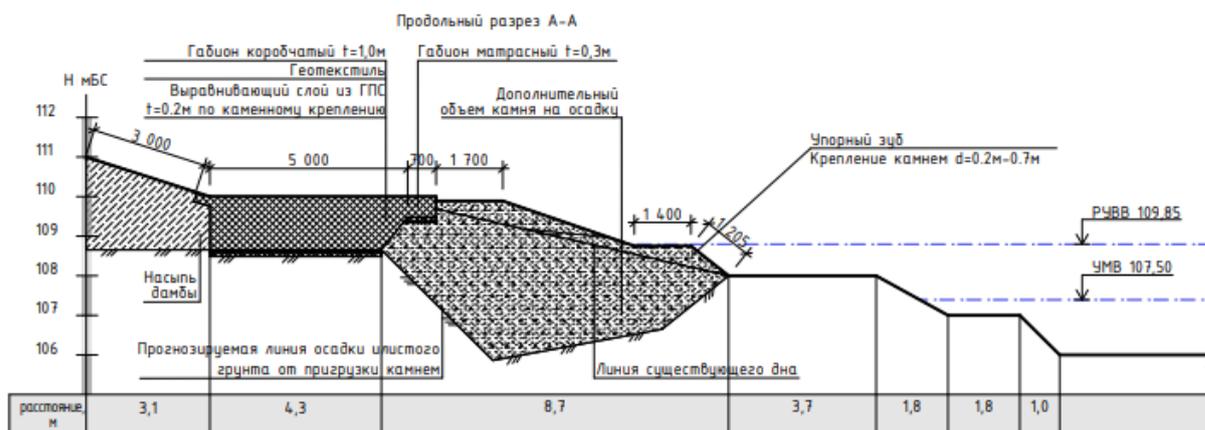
конструкция берегоукрепления с коробчатыми габионами берега устраивается упорный зуб в виде рисбермы из камня.
